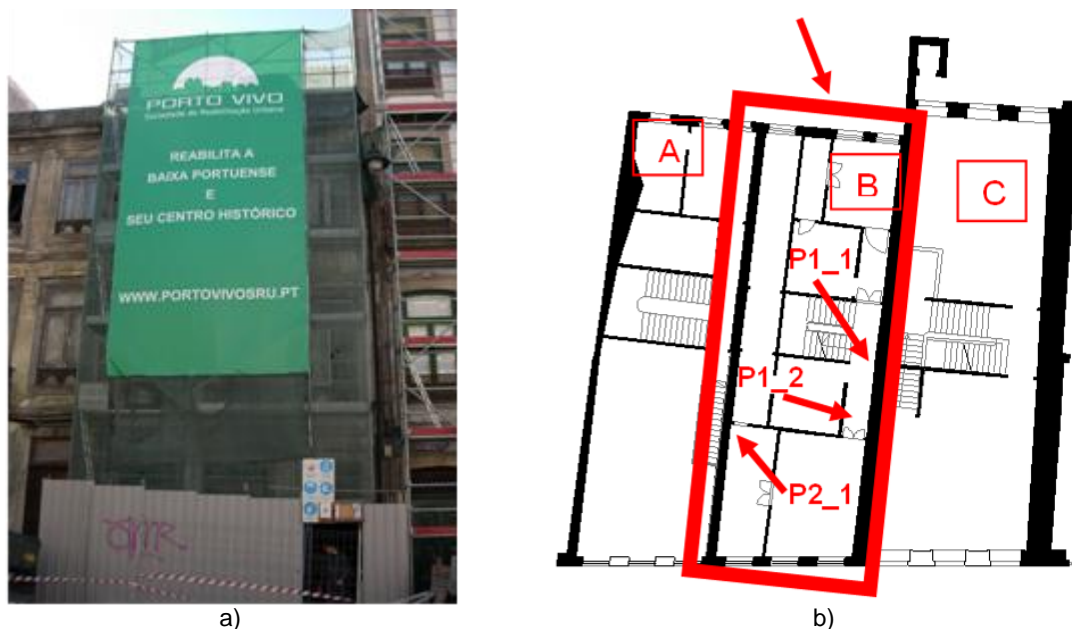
Edifício de Mouzinho da Silveira (B): a) fachada na altura de intervenção; b) vista em planta.
